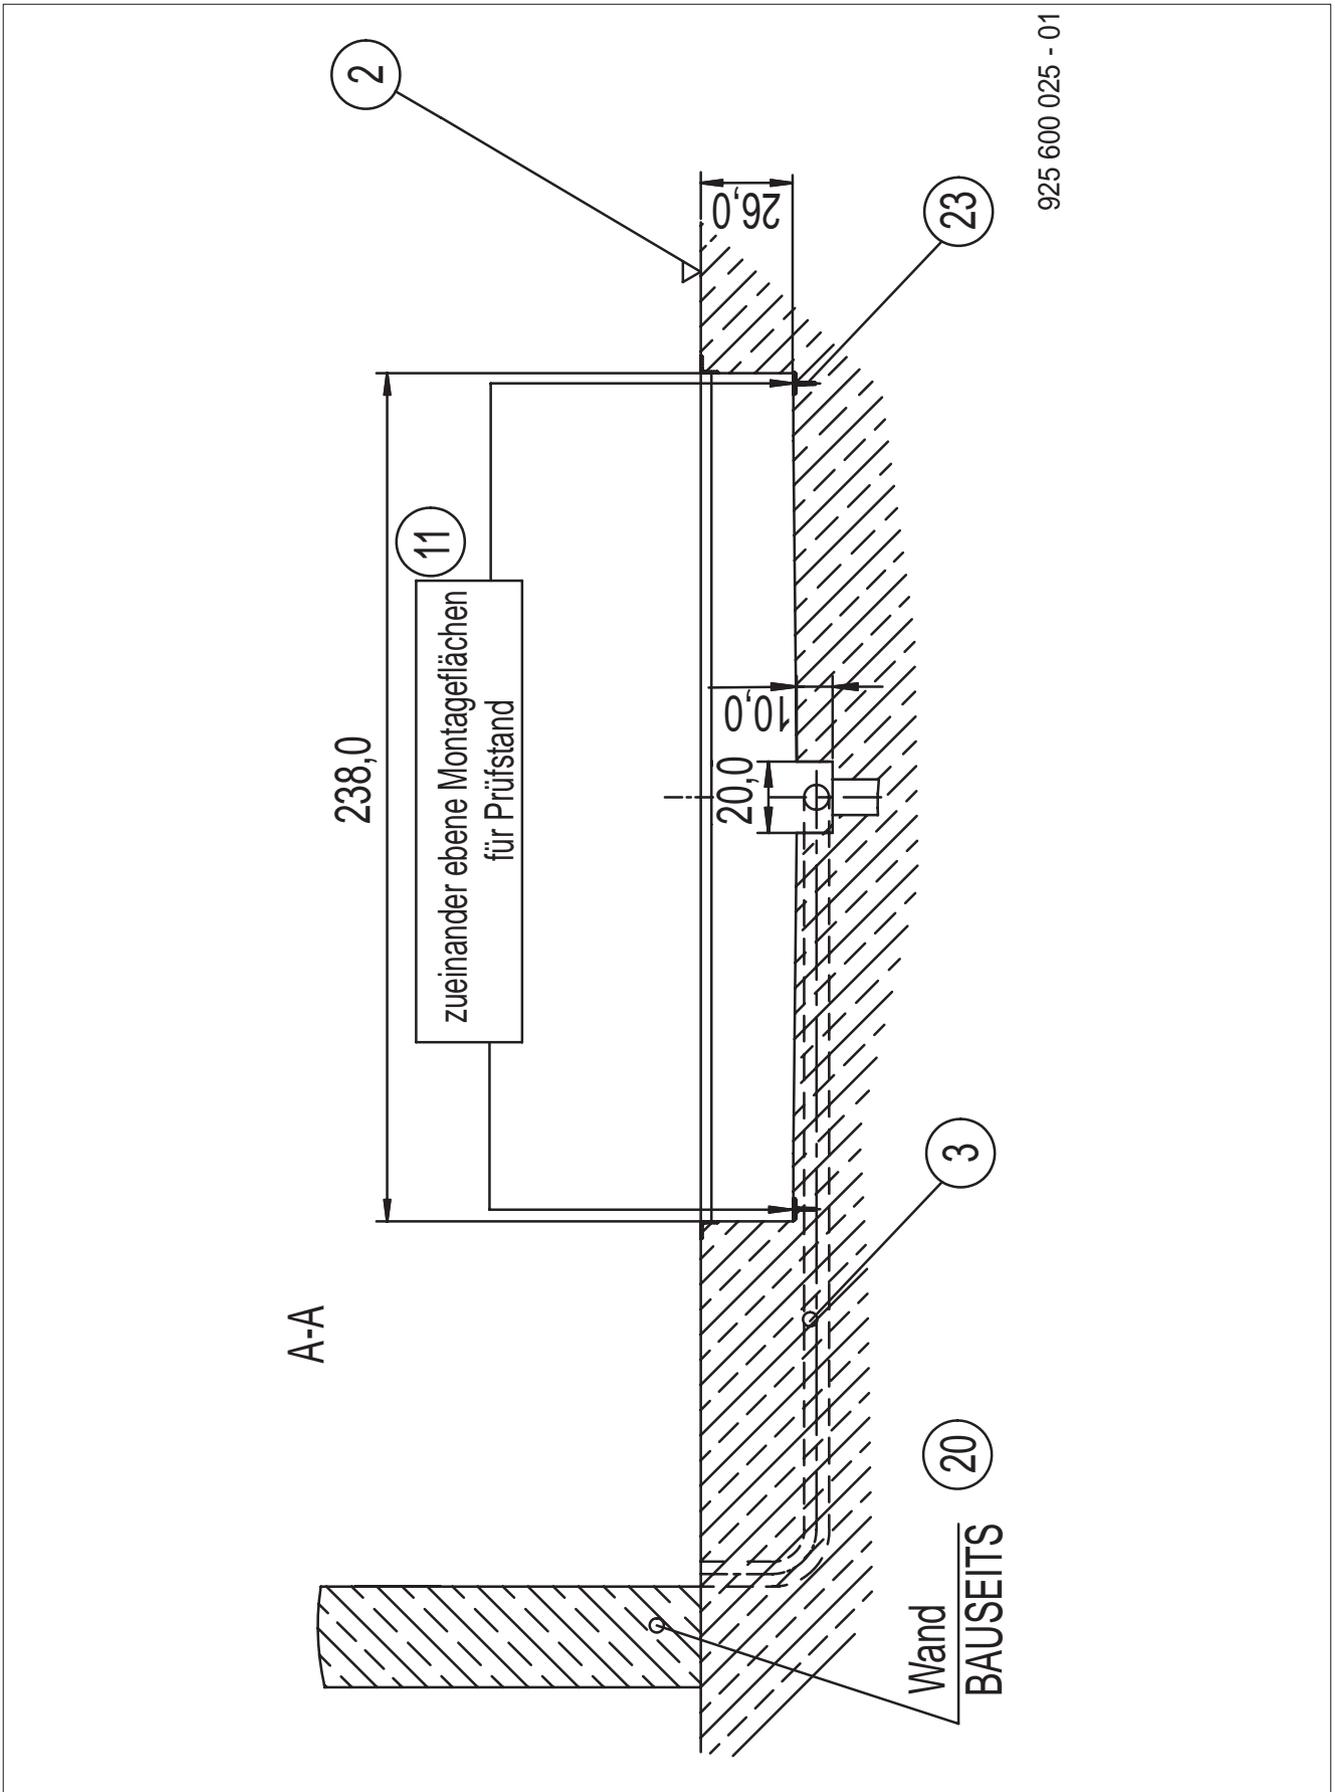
Grubenplan BD 6xx mit Wandhalterung - Schnitt A-A
